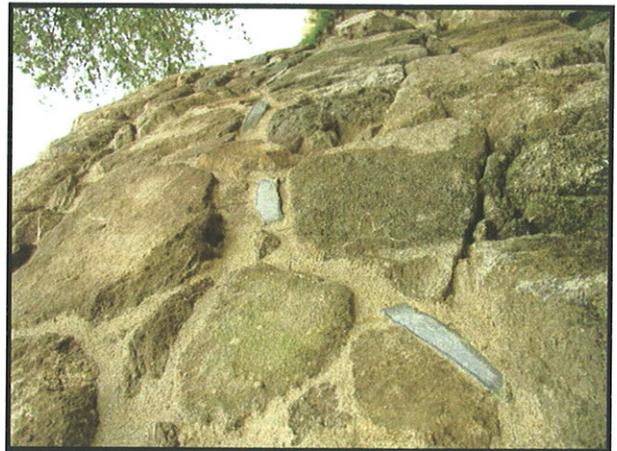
y 94: Planteamiento de elemento diferenciador y vista.
